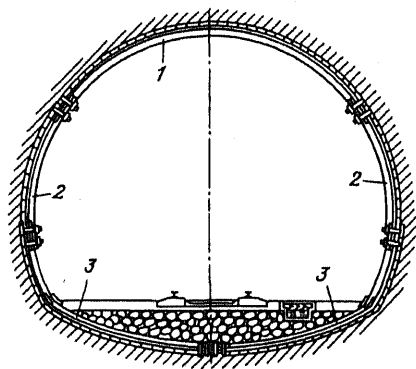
Конструкция арочной металлической податливой крепи с обратным сводом
